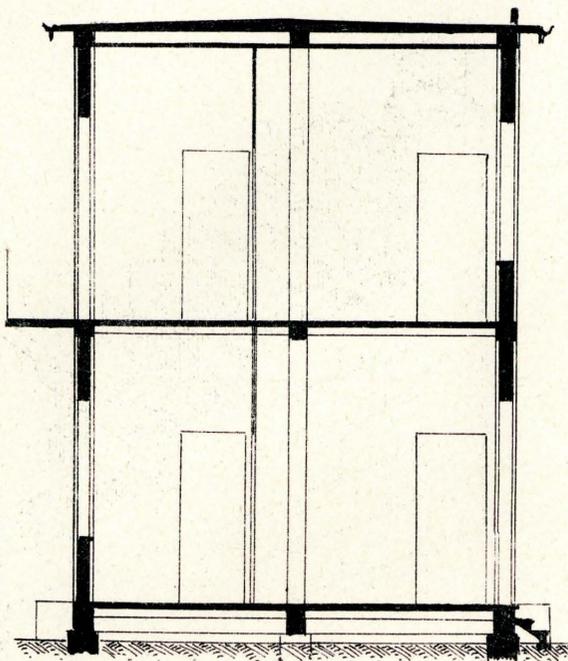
Sezione trasversale di casa a due piani — 1:100.
